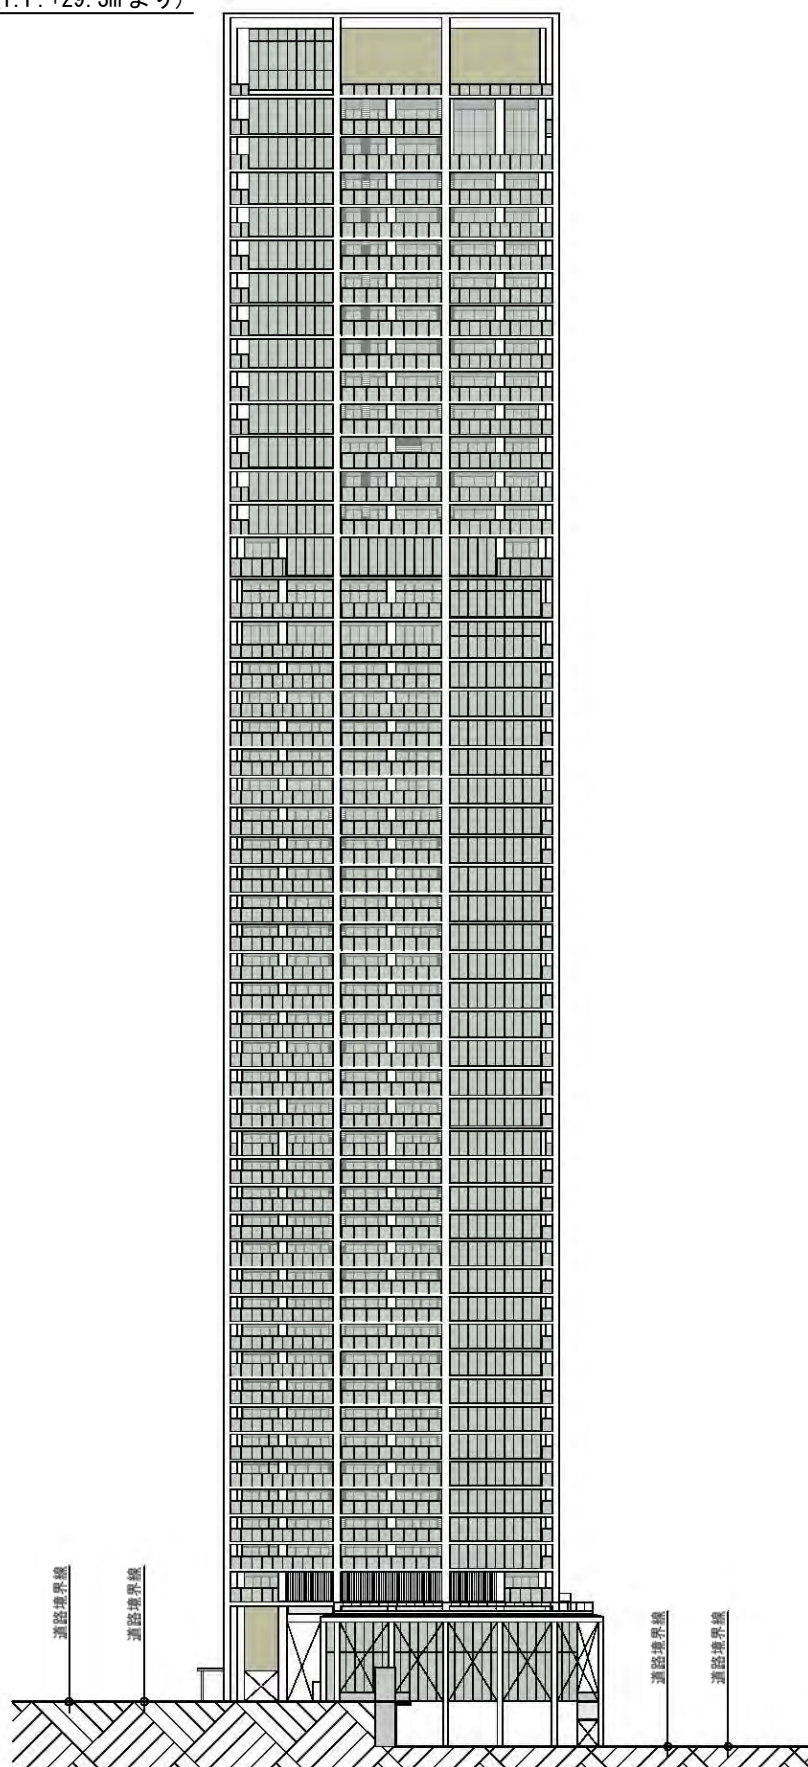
(3) 立面図 (南立面図 S=1:1,000)
